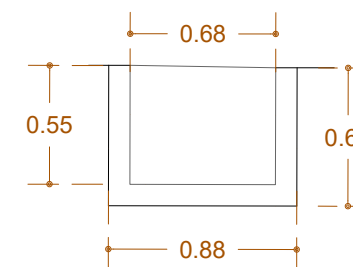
Pilastra Sur de Nave Tramo 1 Vista Frontal
